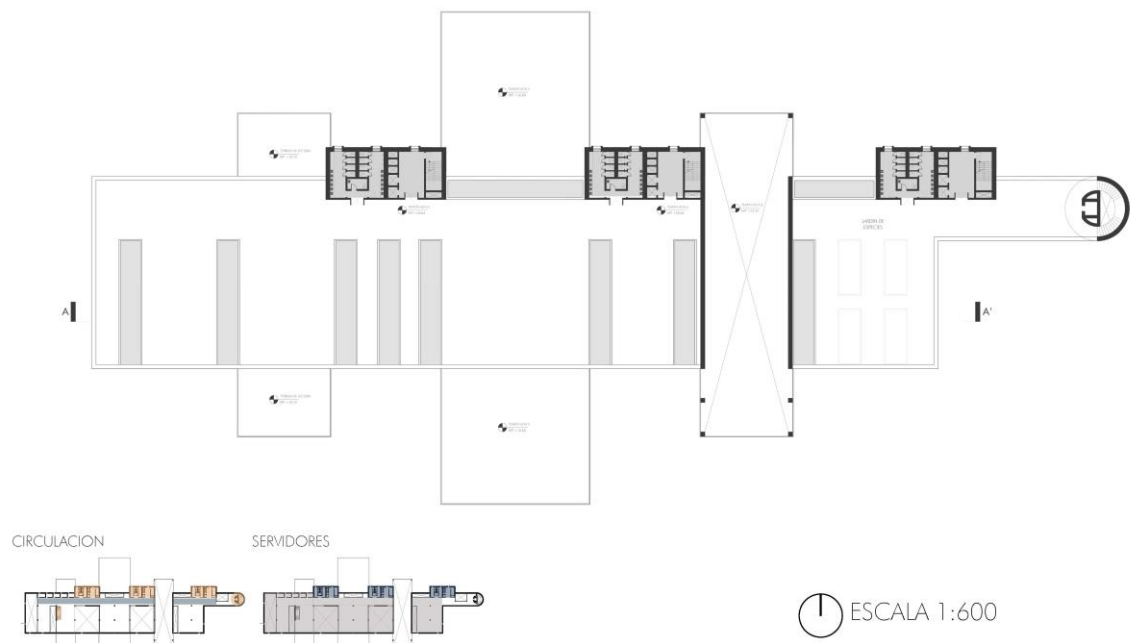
Planta Alta 5 Nivel +16.65 m Fuente: Autor
